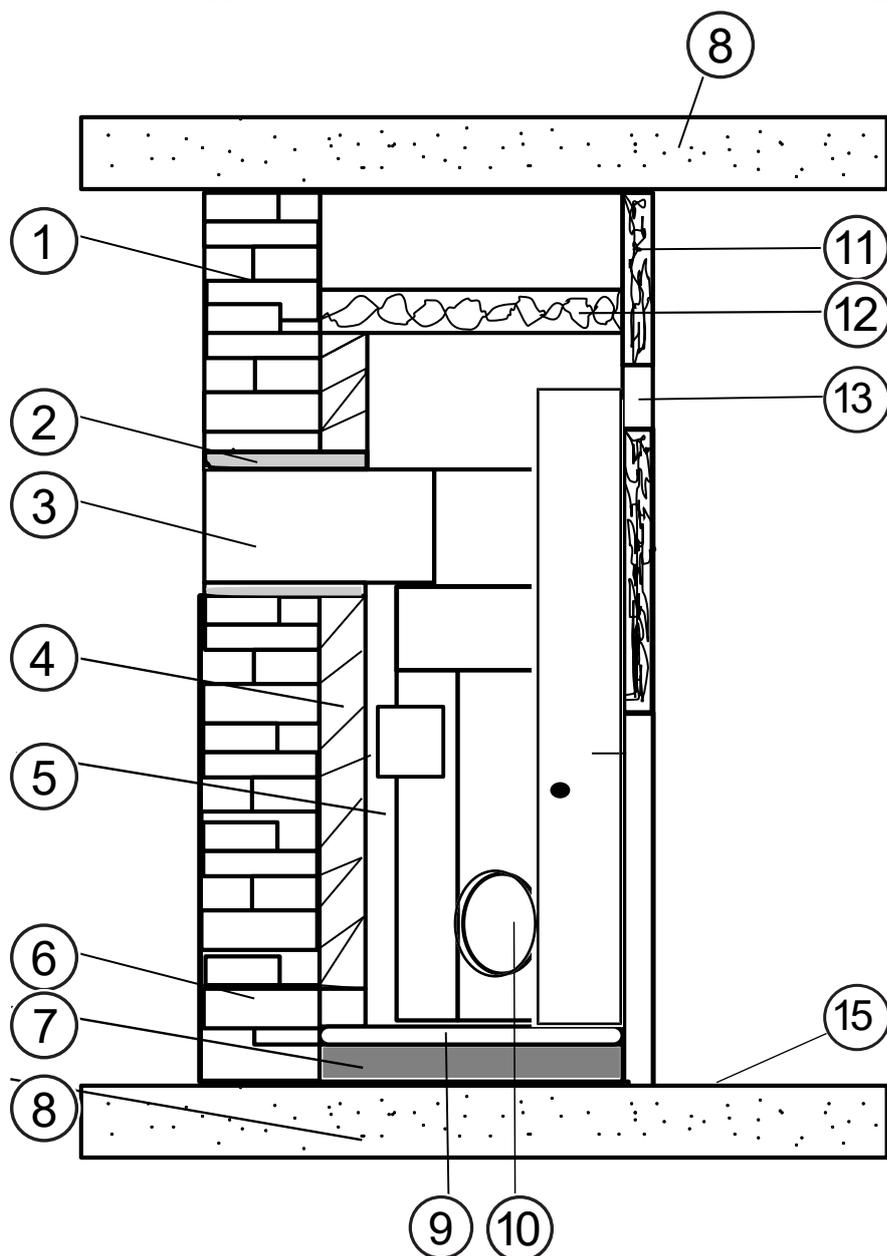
Montaggio davanti/accanto a una parete da proteggere
